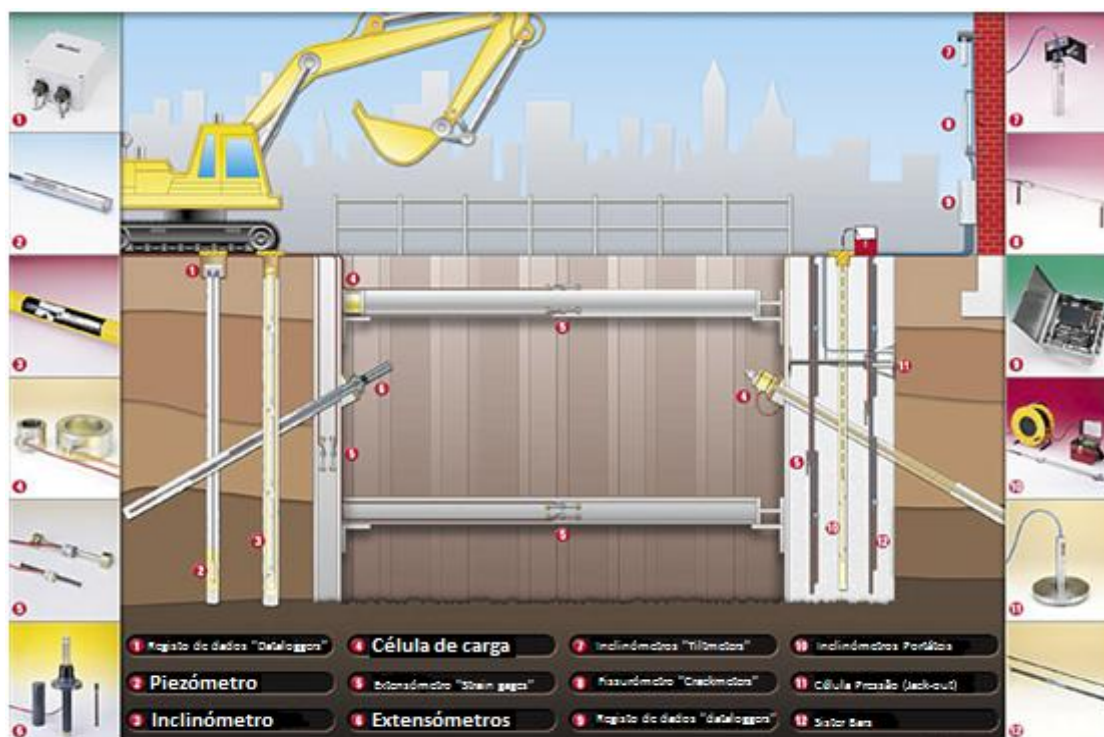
Aplicação em escavação em meio urbano (adaptada Geokon.com, 2012).
